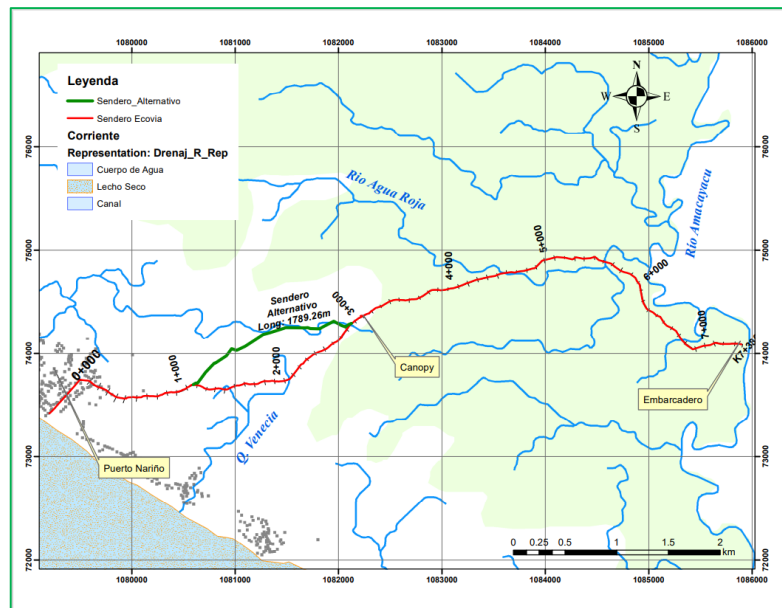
Trazado alternativo propuesto para el sendero Ecovía mostrado en línea verde
